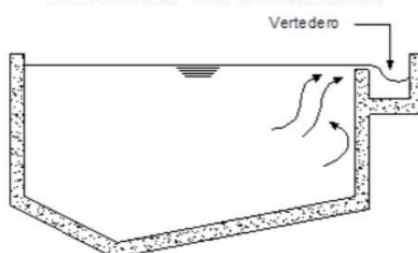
Esquema de la tolva de arenas – planta
